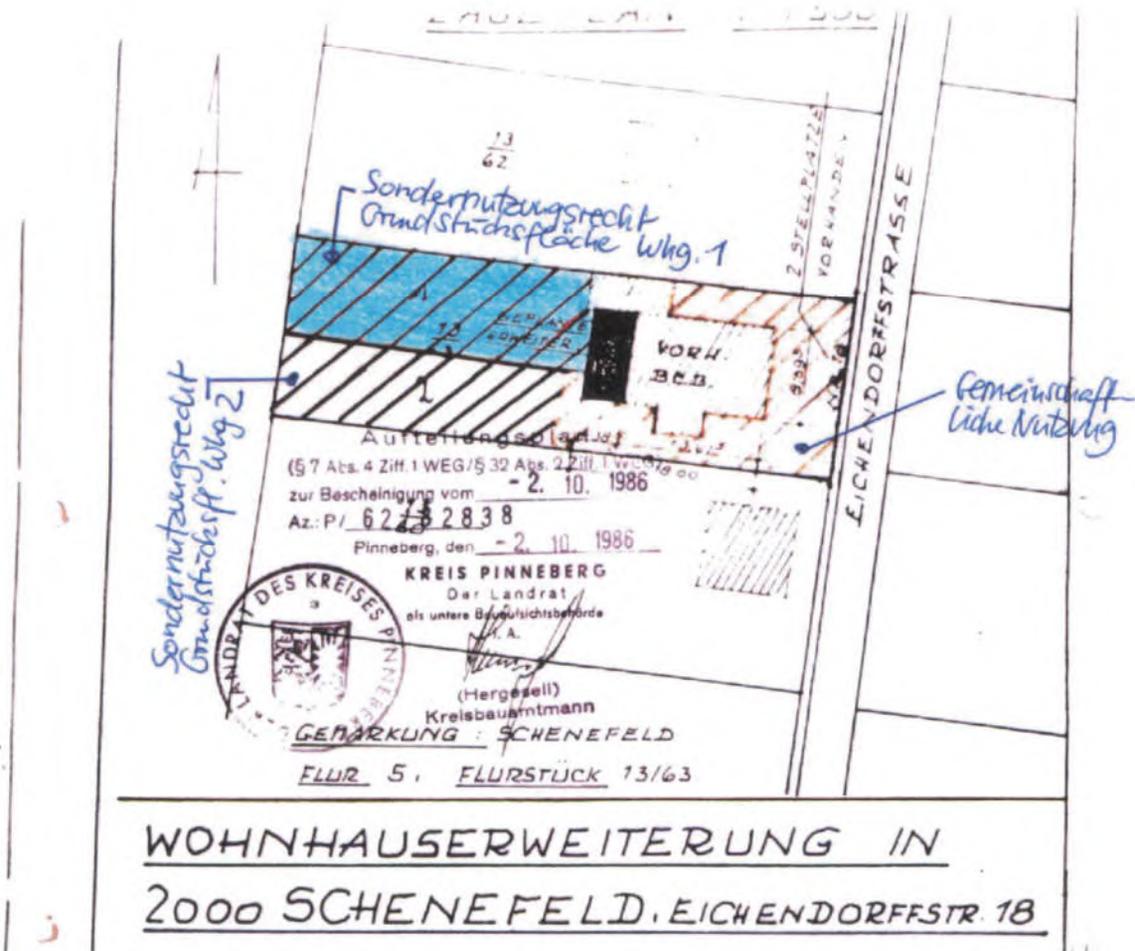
Lageplan mit Kennzeichnung Sondernutzungsrecht Grundstücksfläche
